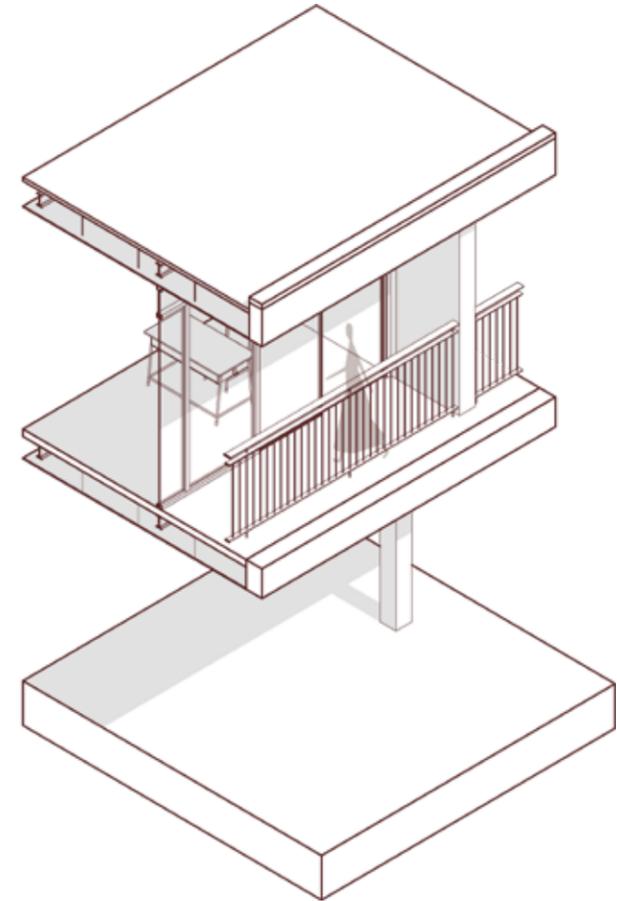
Axonometría sección constructiva Fuente: Elaboración propia.
